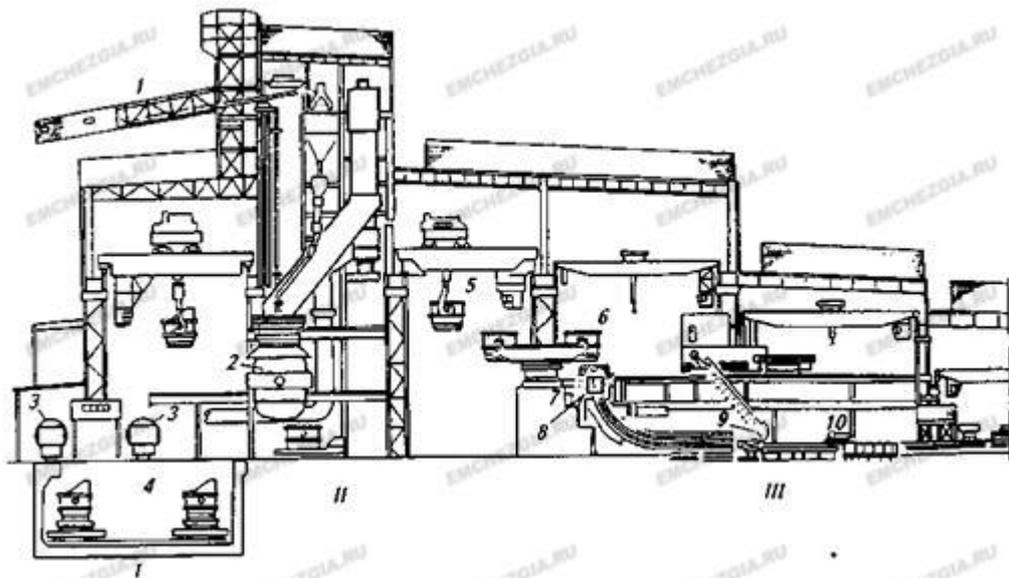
Разрез здания конвертерного цеха (западноевропейский завод): I — загрузочный пролет; II — конвертерный пролет; III — отделение непрерывной разливки; 1 — конвейер для подачи флюсов; 2 — 310-т конвертер; 3 — передвижной миксер типа «Торпедо» емкостью 7600 т; 4 — приямок для ковшей перелива чугуна; 5 — ковш со сталью; 6 —
